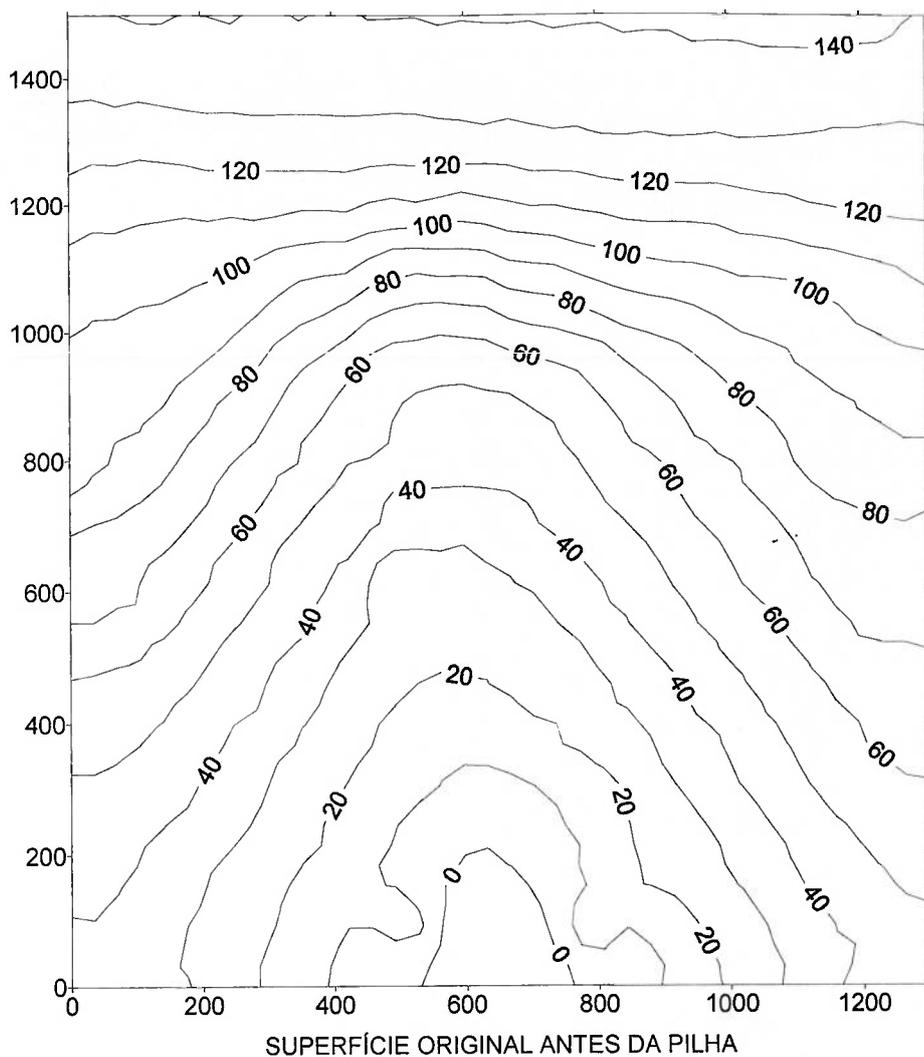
Planta planialtimétrica da área anterior à pilha
